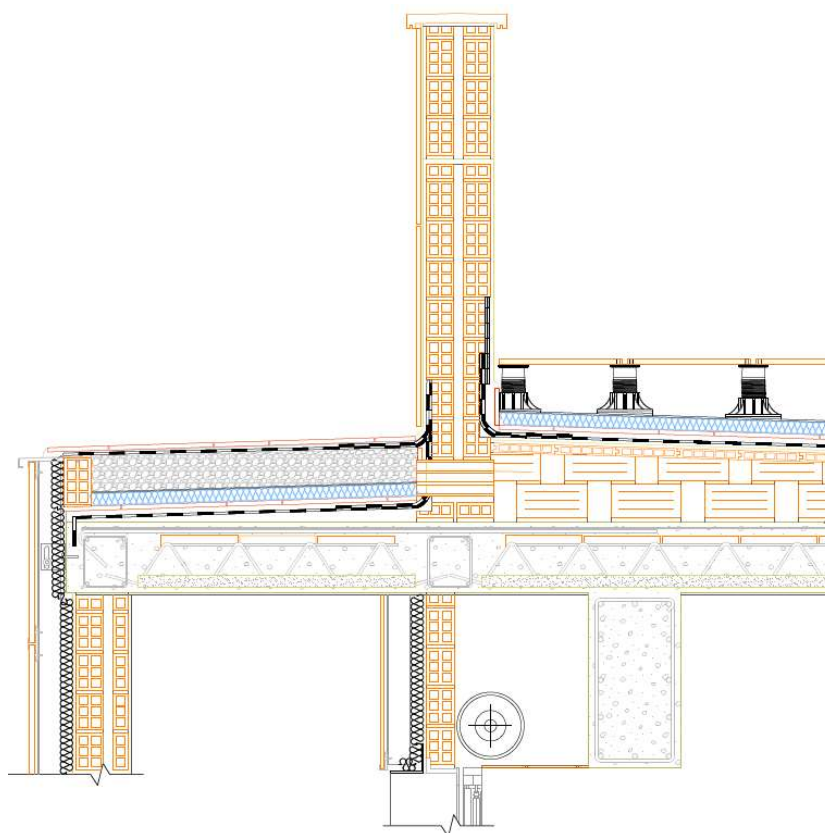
Sección cubiertas rehabilitadas, (Fuente: autor) * ver plano nº 14
